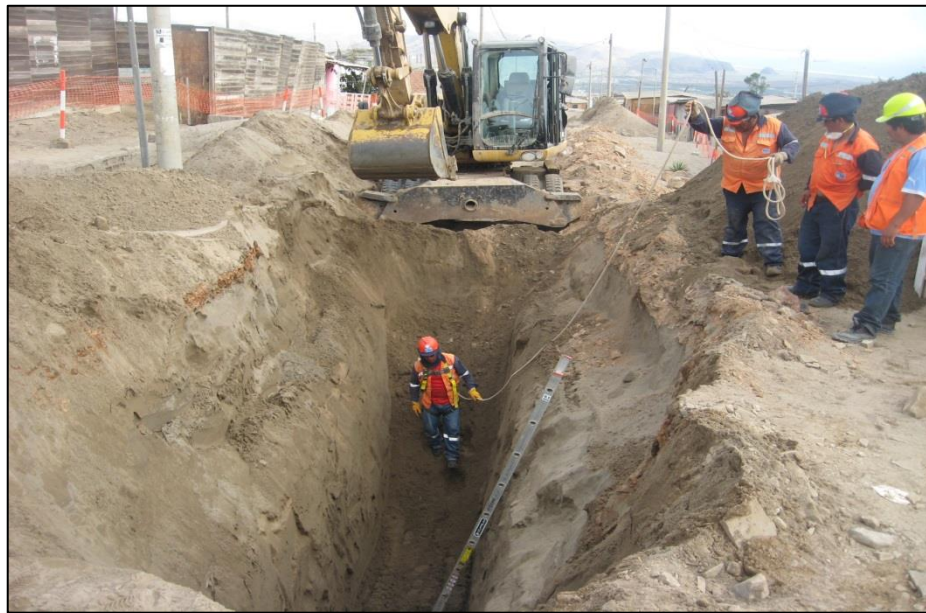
Culminación de la aplicación de excavación tipo III (TIII-003).
